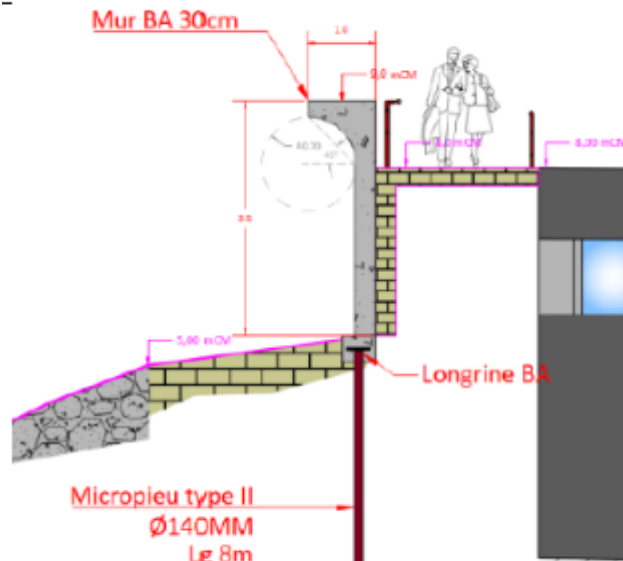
Plan du mur de protection incurvé sur la jetée principale
